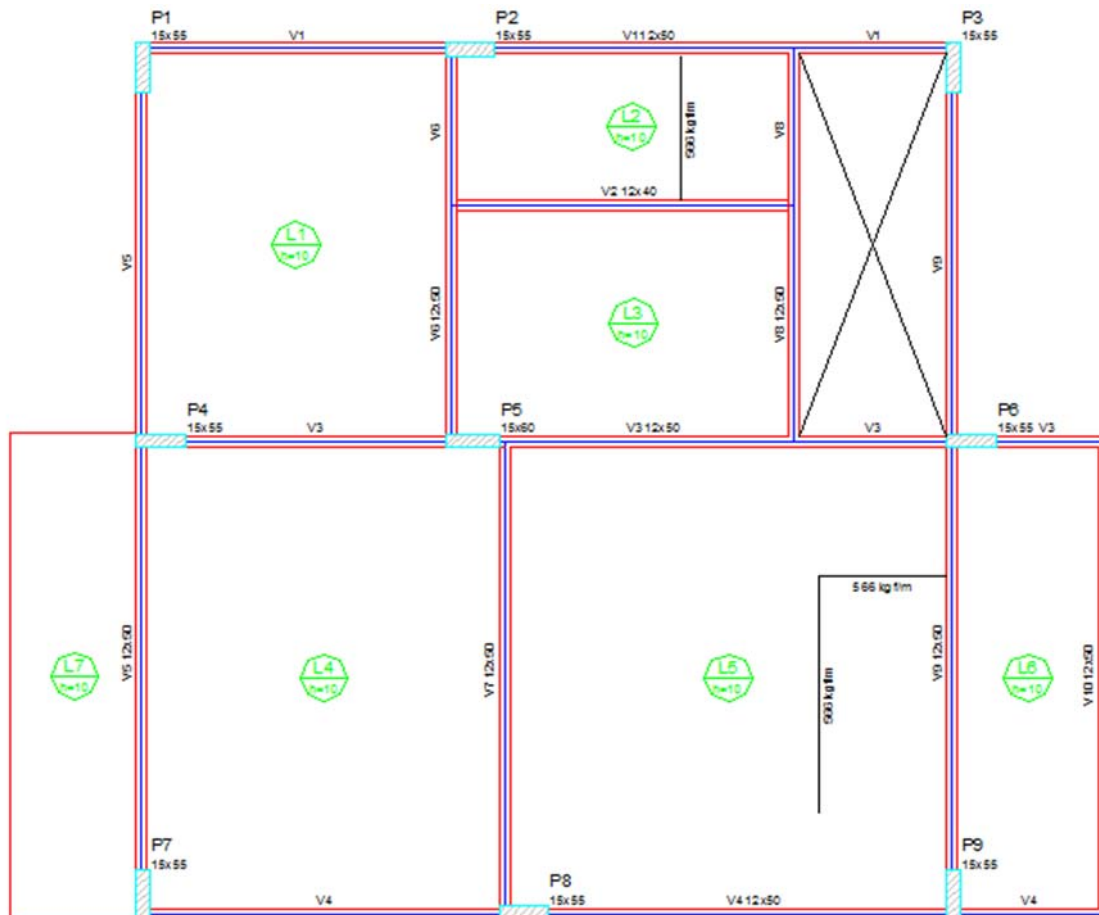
Planta de forma do pavimento TIPO 1 (Nível 300)
